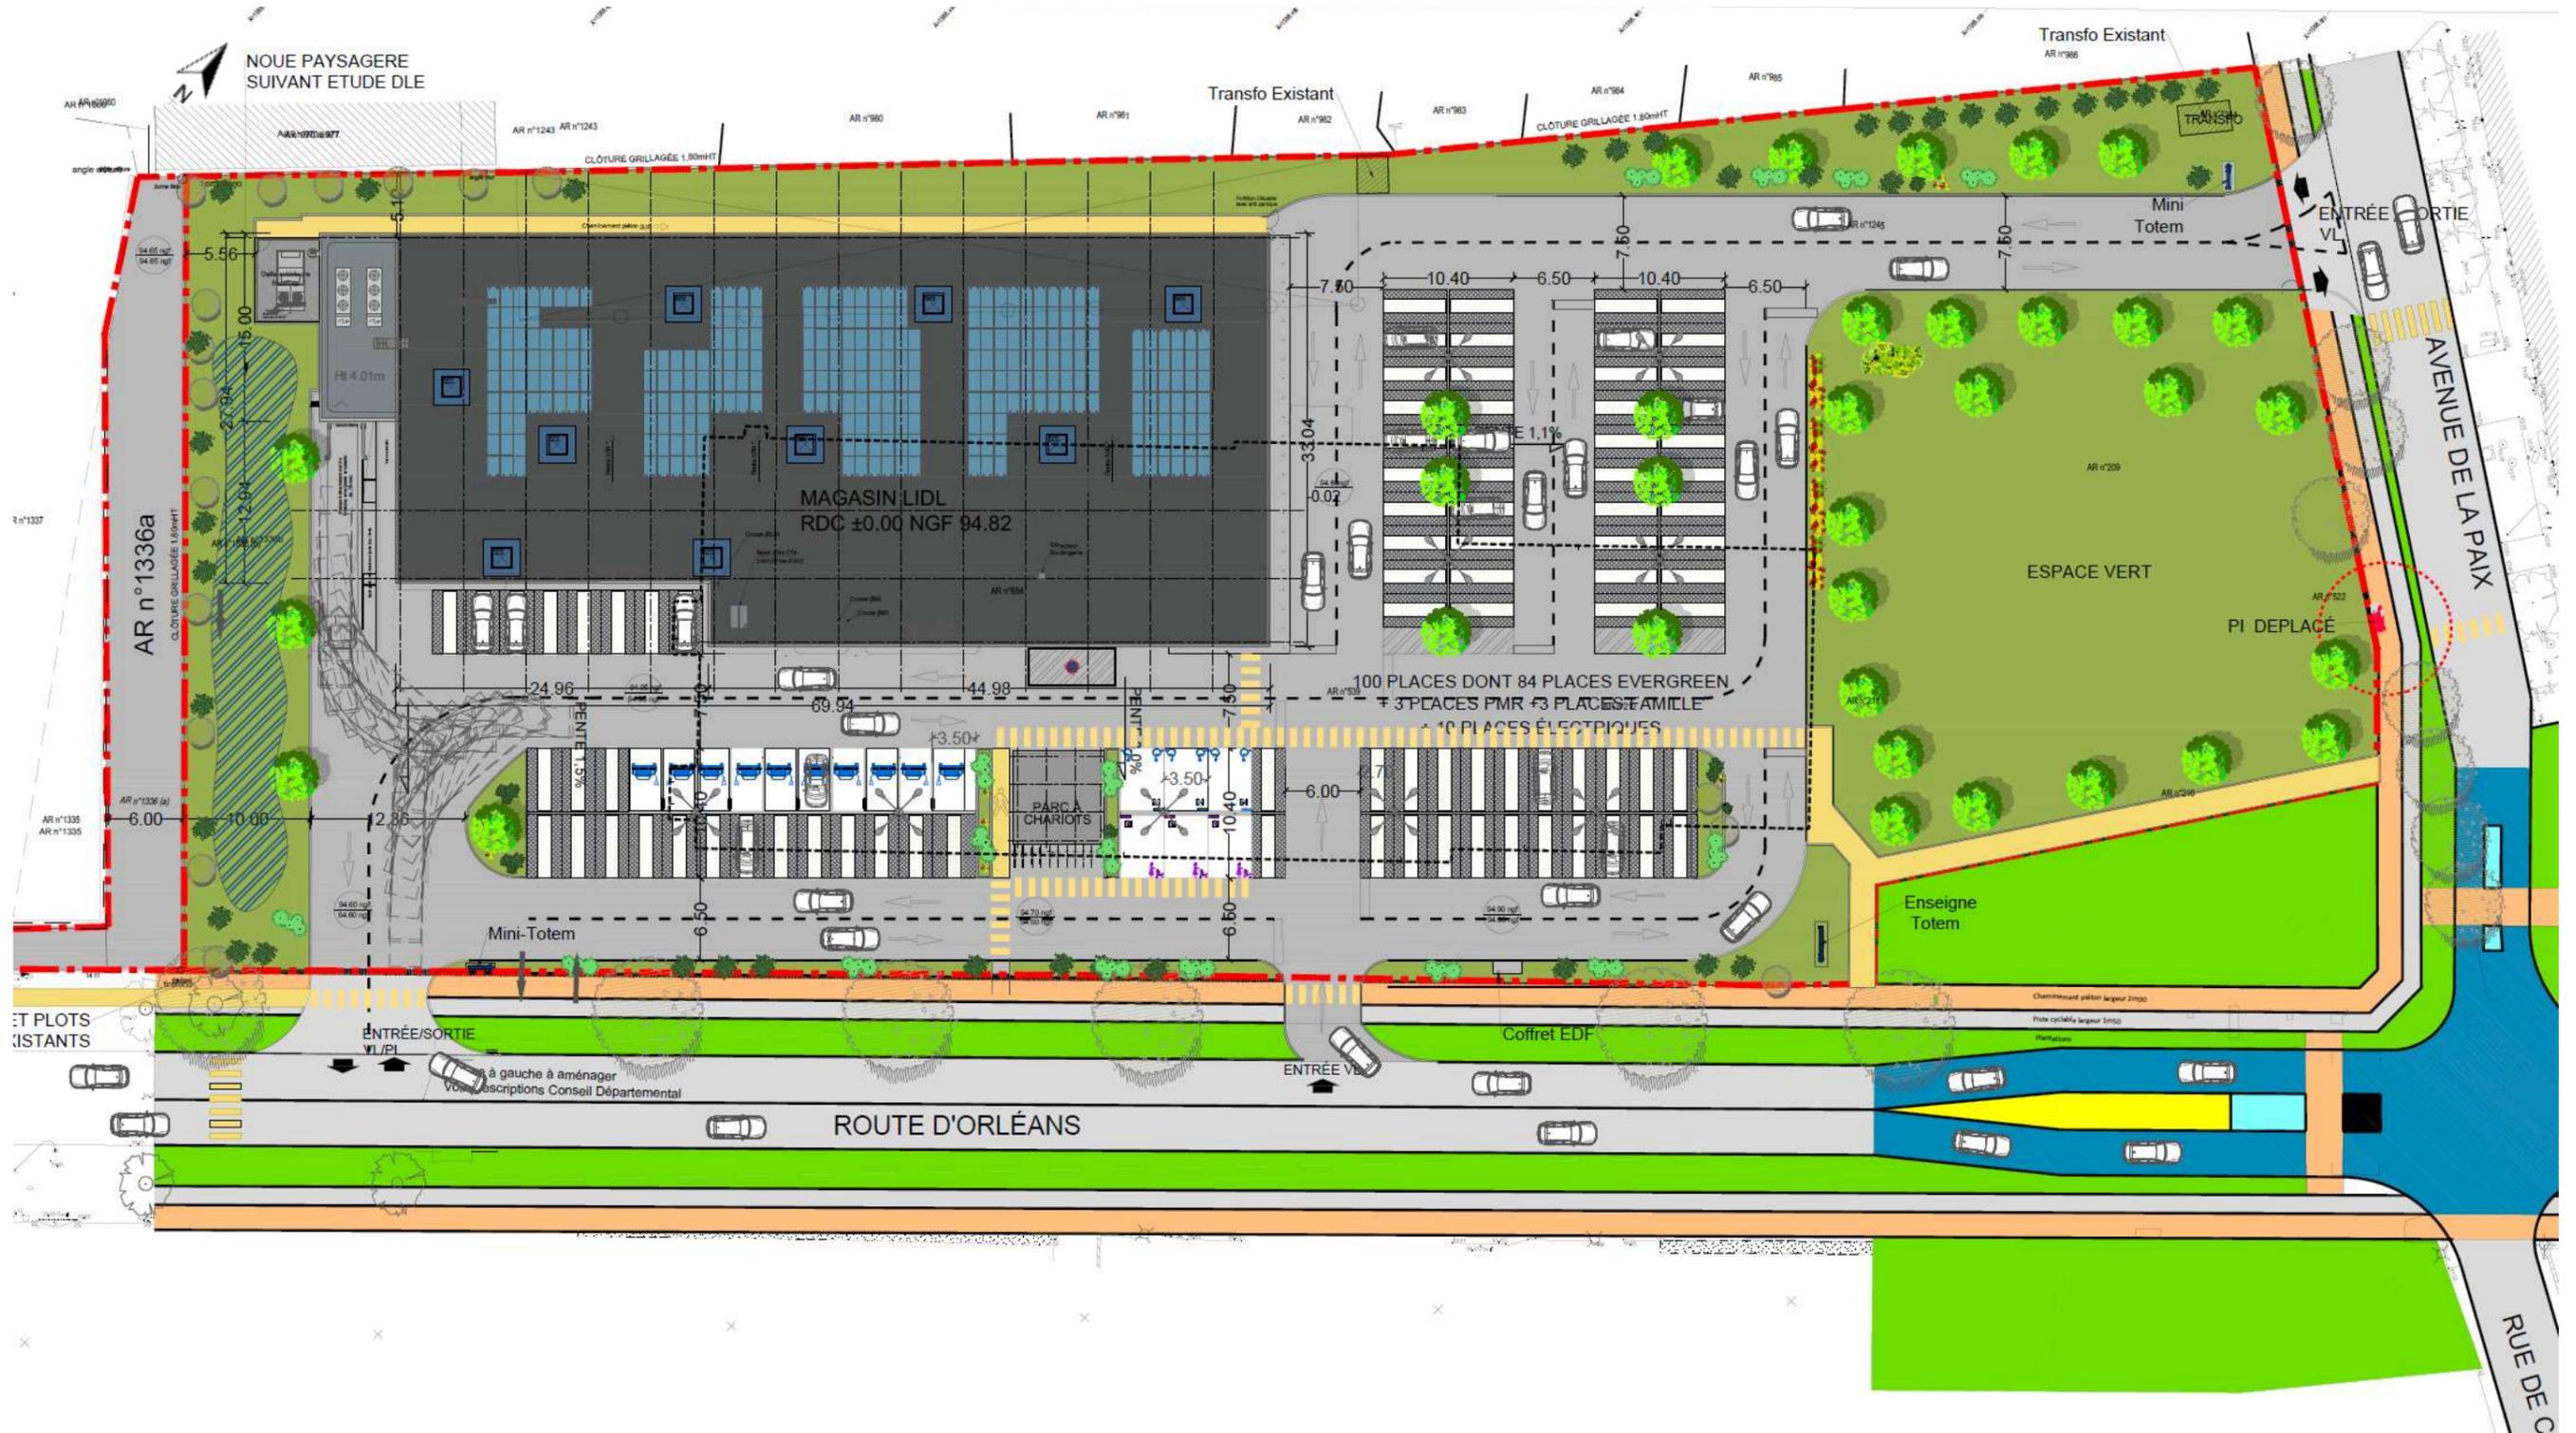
Plan de masse du projet (Source : COMM Archit)
